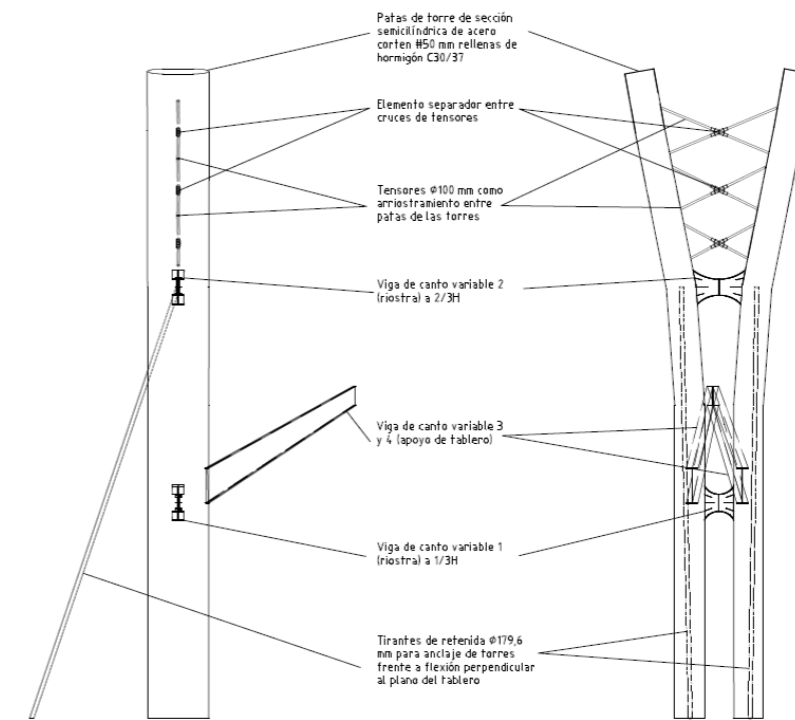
Definición de los elementos estructurales de las torres. Fuente: Elaboración Propia (AutoCAD)
